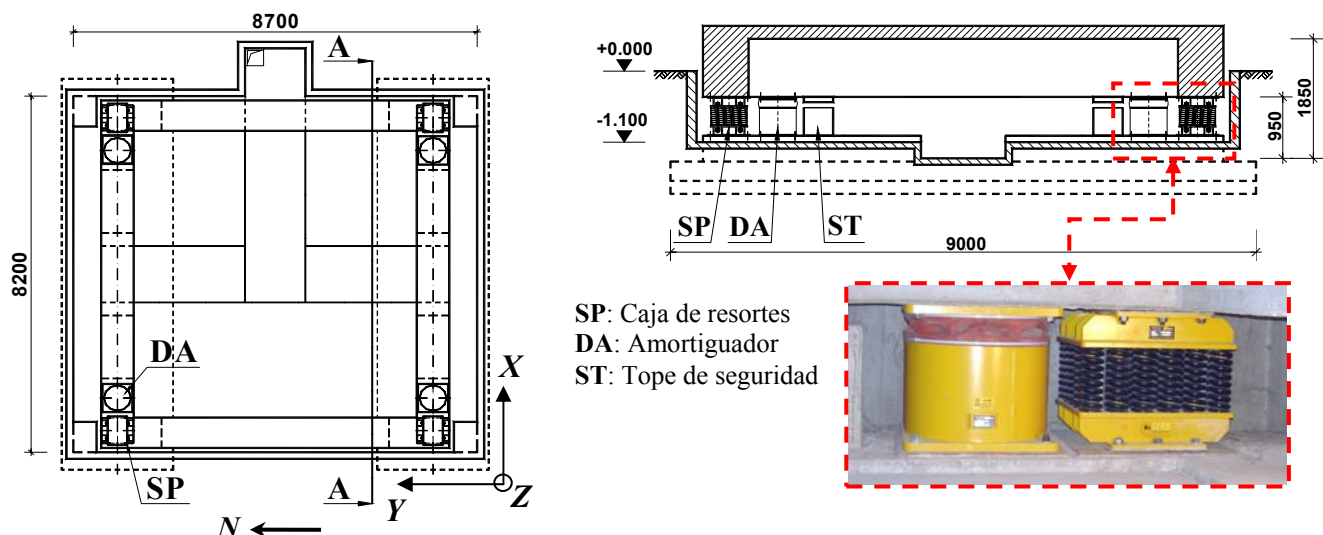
Vista y corte del edificio aislado, zona de fundación.
